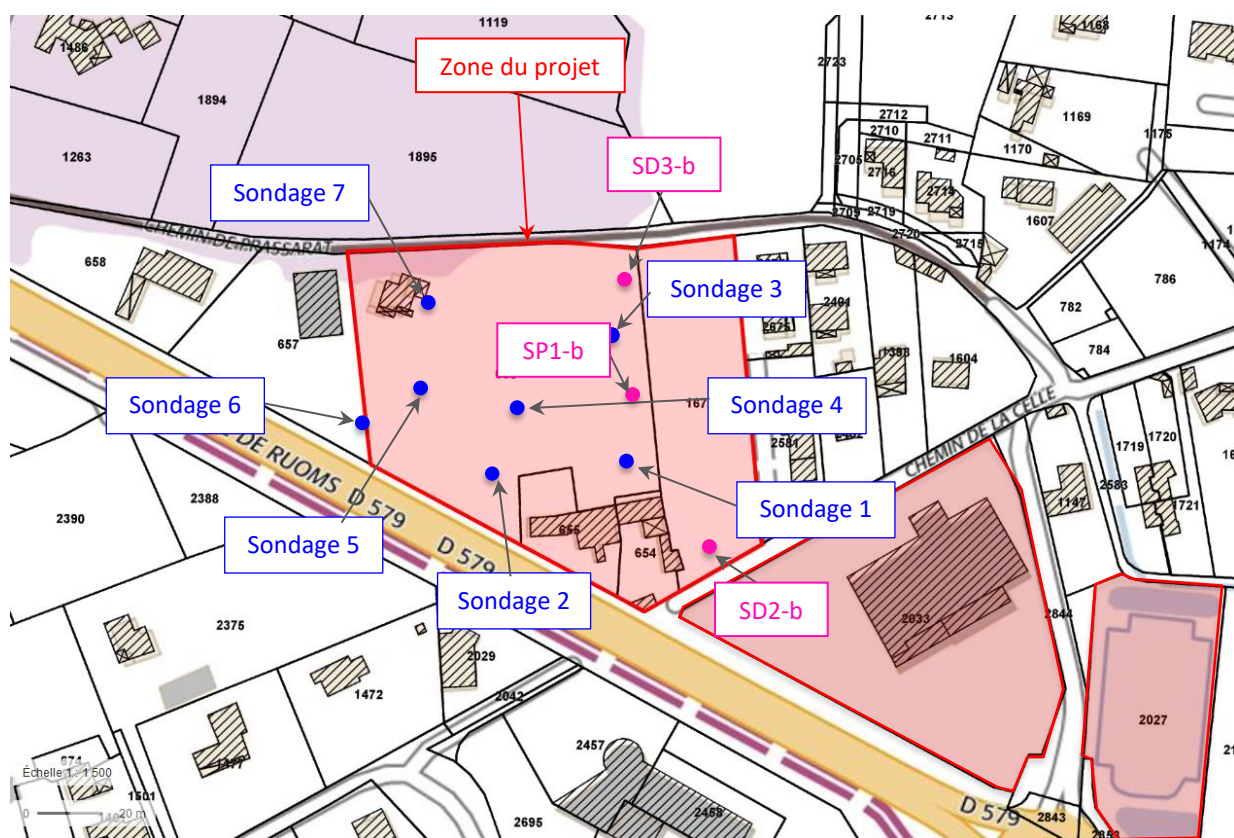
Localisation des forages d'investigation et données piézométriques sur fond de carte IGN et plan cadastral (Source : Etude géotechnique - FONDASOL)
